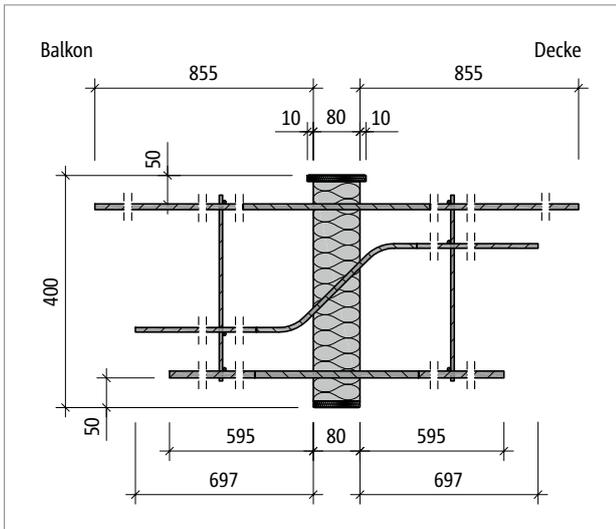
Schöck Isokorb® T Typ B-M1: Produktschnitt
